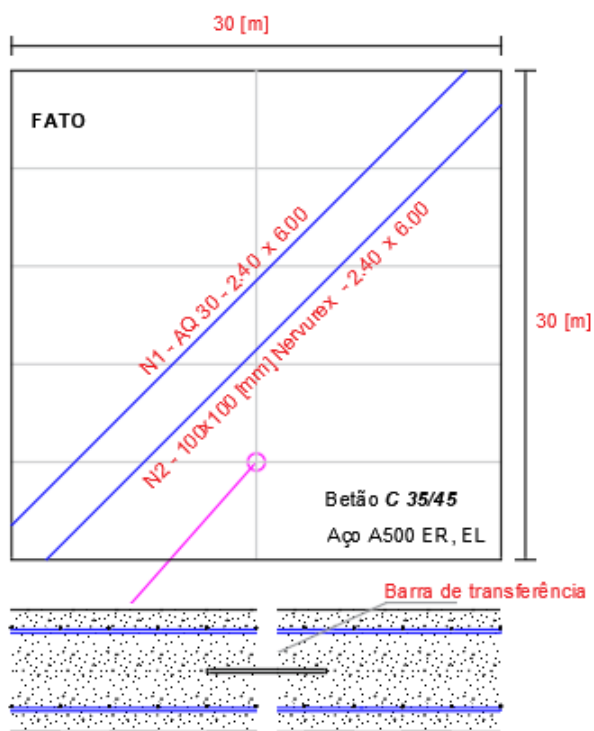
Pormenor da disposição de armaduras no pavimento da FATO.
